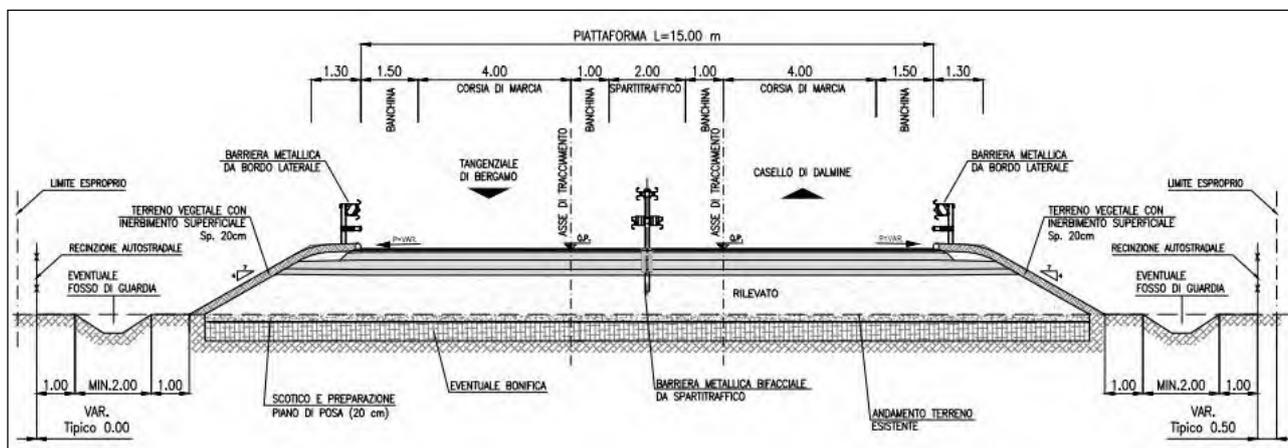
Sezione tipo rampa bidirezionale a 2 corsie
